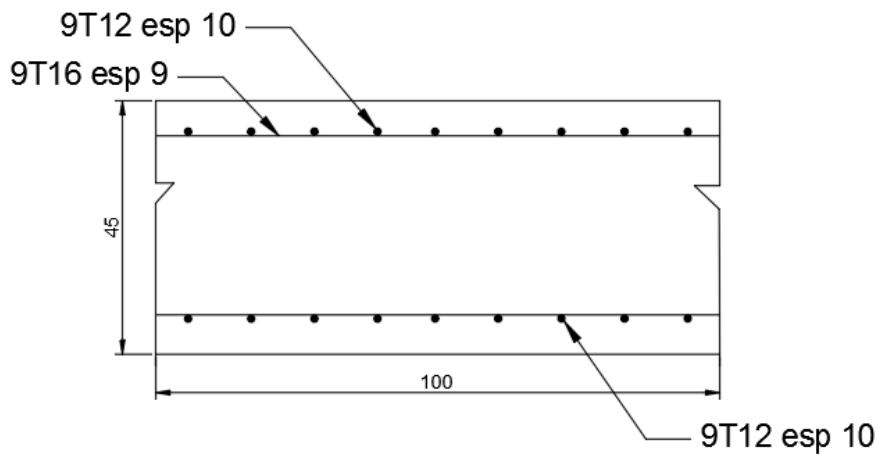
Ferrailage de la dalle du radier sur travée sens Y-Y (cm).
